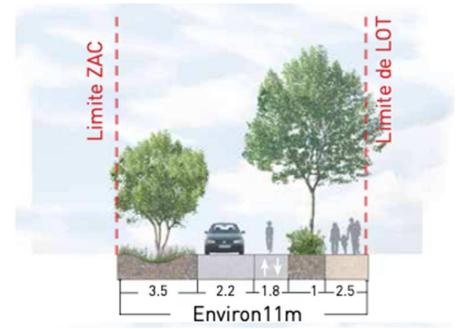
Coupe DD' sur la voie nouvelle (Ville de Roanne)
